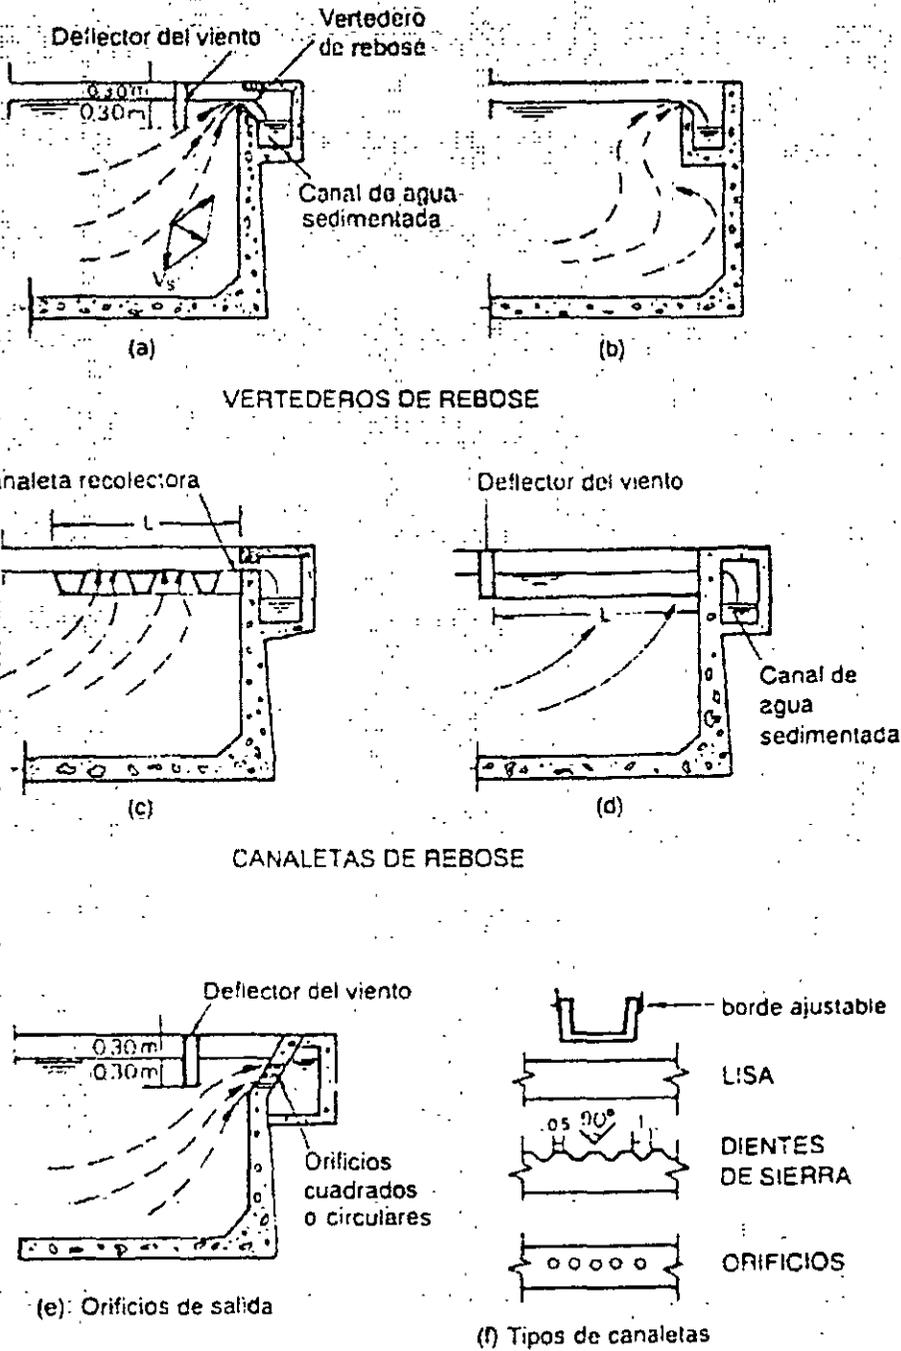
Estructuras de salida en sedimentadores rectangulares
